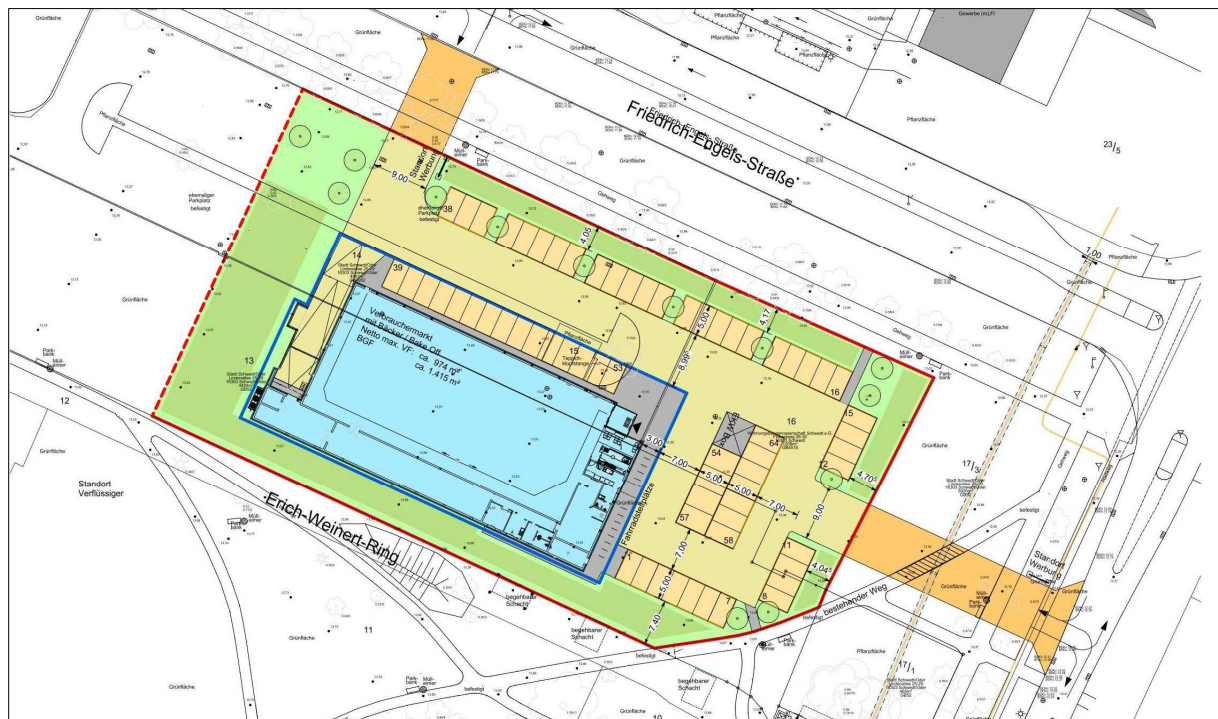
Lageplan Grundriss (o.M.)
